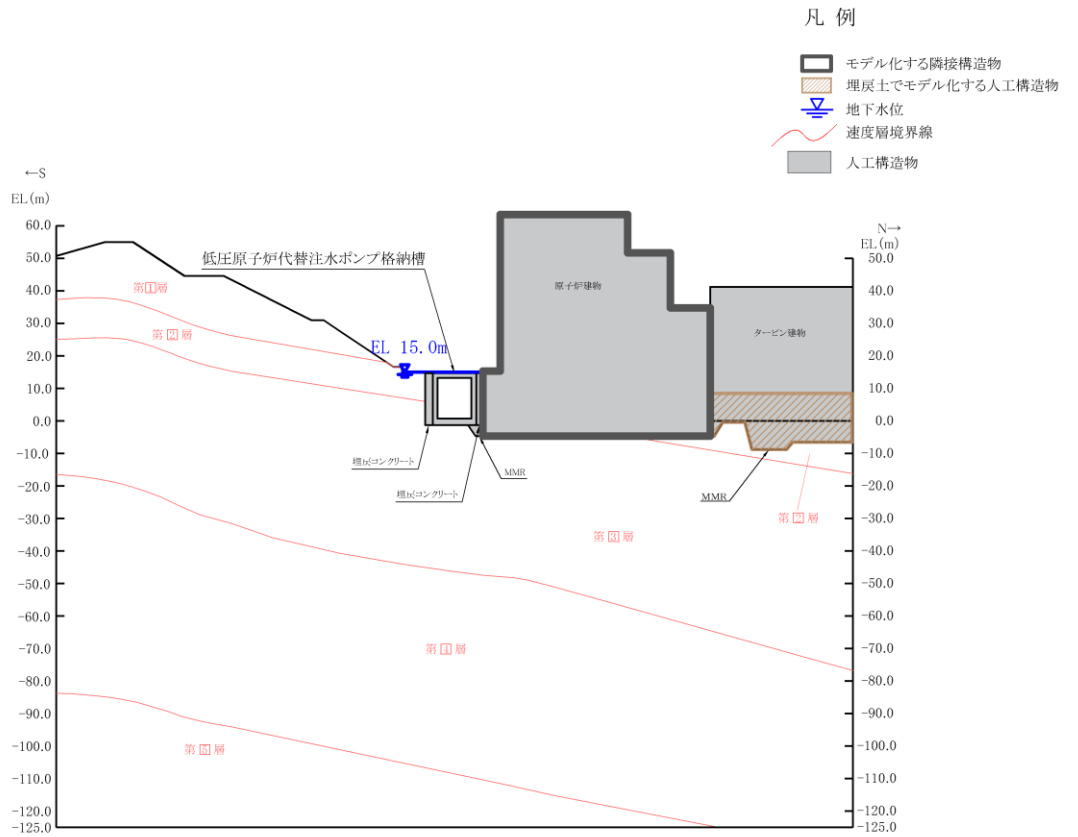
低圧原子炉代替注水ポンプ格納槽 評価対象断面図 (B-B断面)
